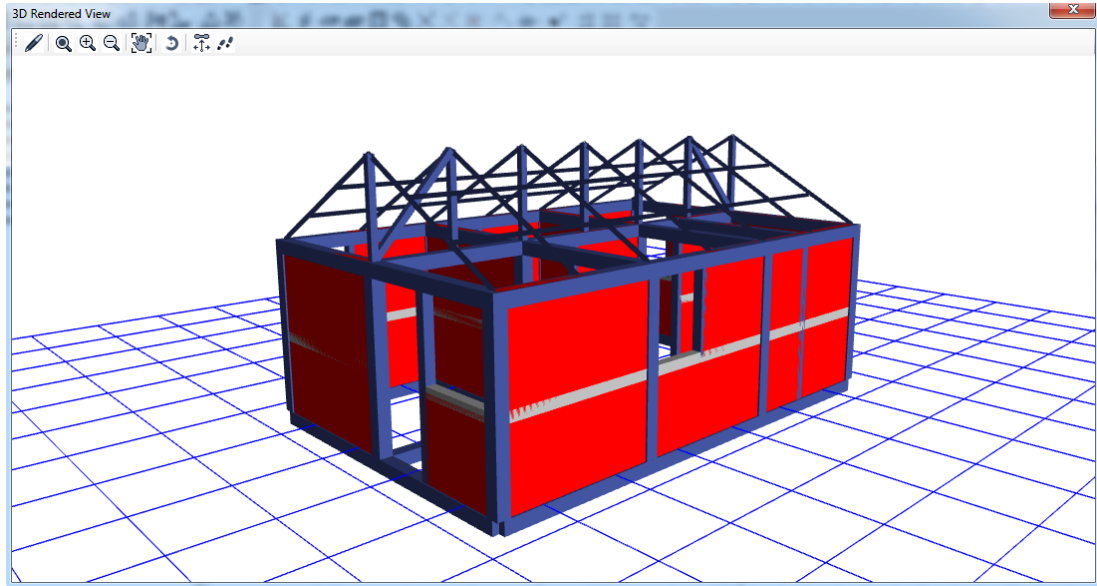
Vista en perspectiva de la vivienda con mampostería.
